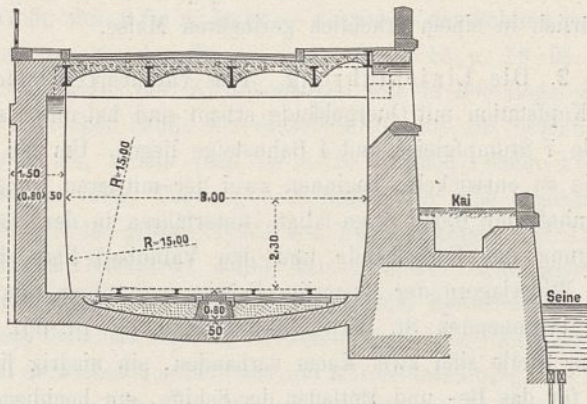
Querschnitt des Tunnels mit gerader Decke. 1:200.
